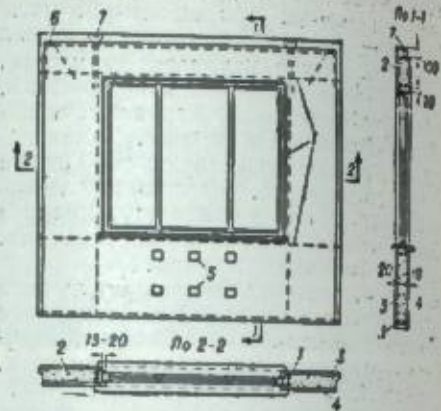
Однослойная керамзитобетонная панель наружной стены: 1 — армирующие сварные каркасы; 2 — легкий бетон; 3 — декоративный бетон; 4 — внутренний отделочный слой; 5 — деревянные пробки для крепления опалубочных приборов; 6 — закладные детали; 7 — подъемные петли.
